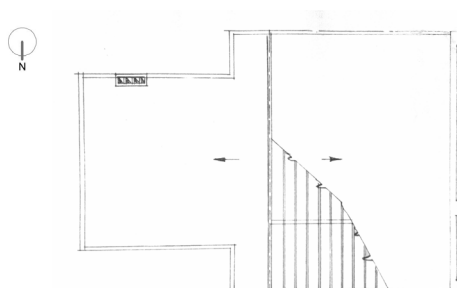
Plano de cubierta del edificio situado en la Rúa Celso Rivas Pérez, 7 (fotografía de autoría propia).
